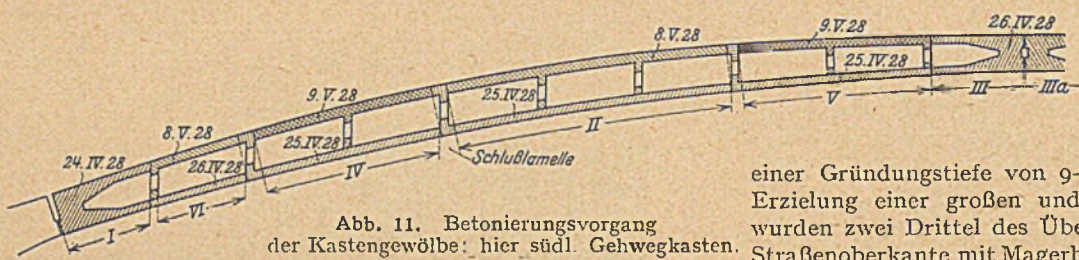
Betonierungsvorgang der Kastengewölbe: hier süd. Gehwegkasten.
